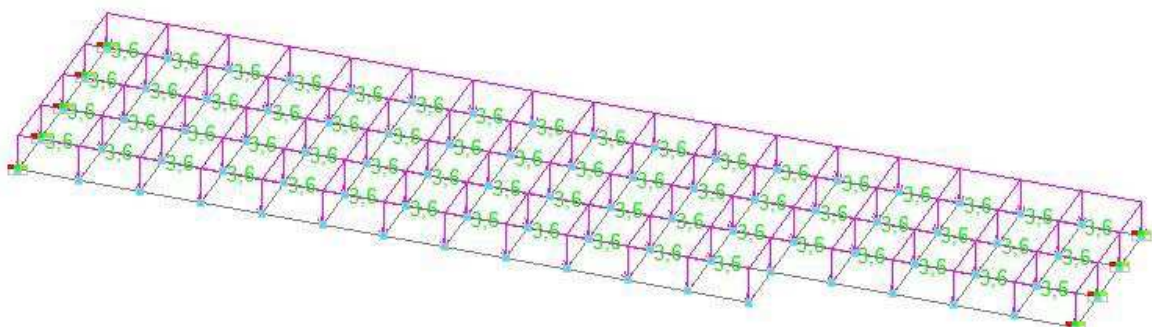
Схема загрузки плиты кратковременной нагрузкой
